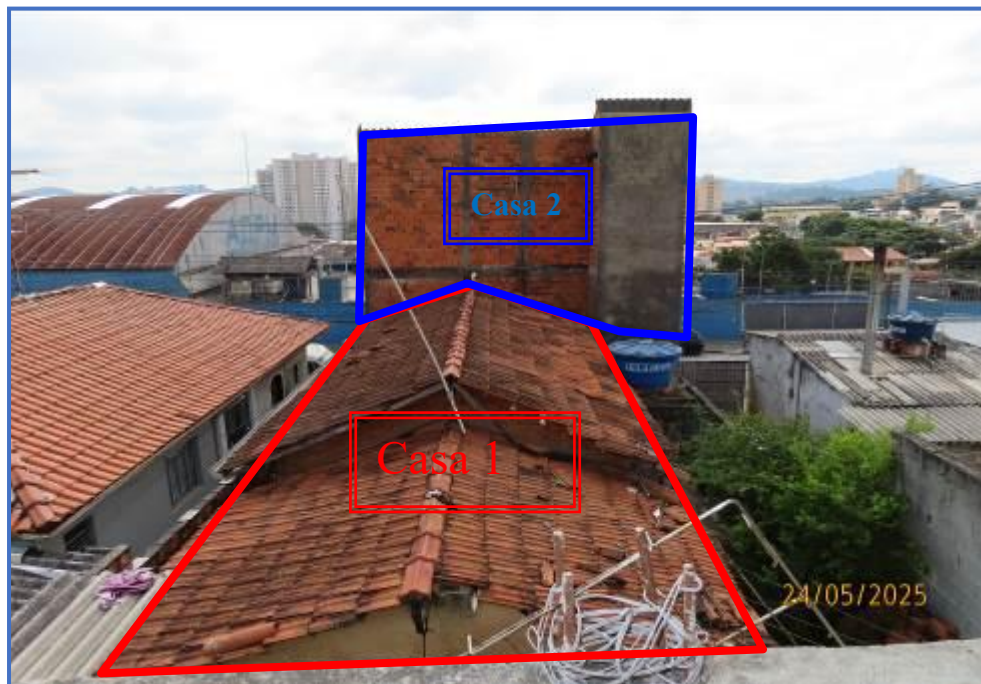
Vista geral do Terreno e das construções nele existentes
